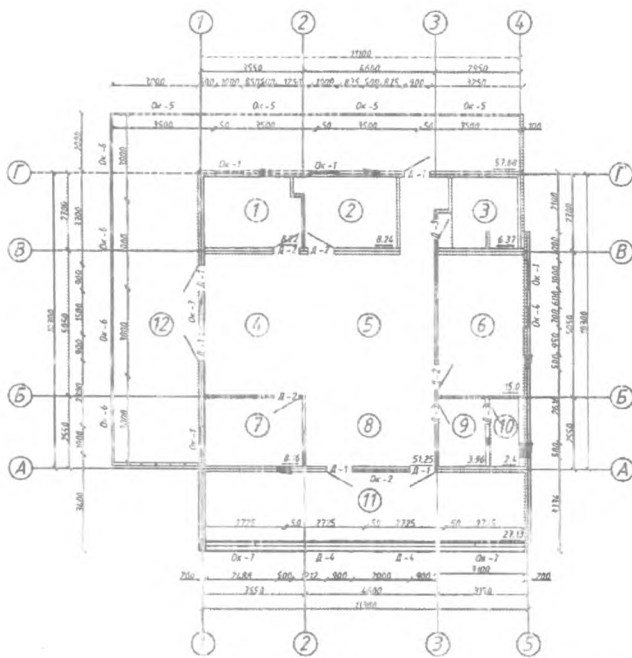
Объемно-планировочное решение одноэтажного жилого дома: План на отметке 0.000и и фасады 1-5 и А-Г
